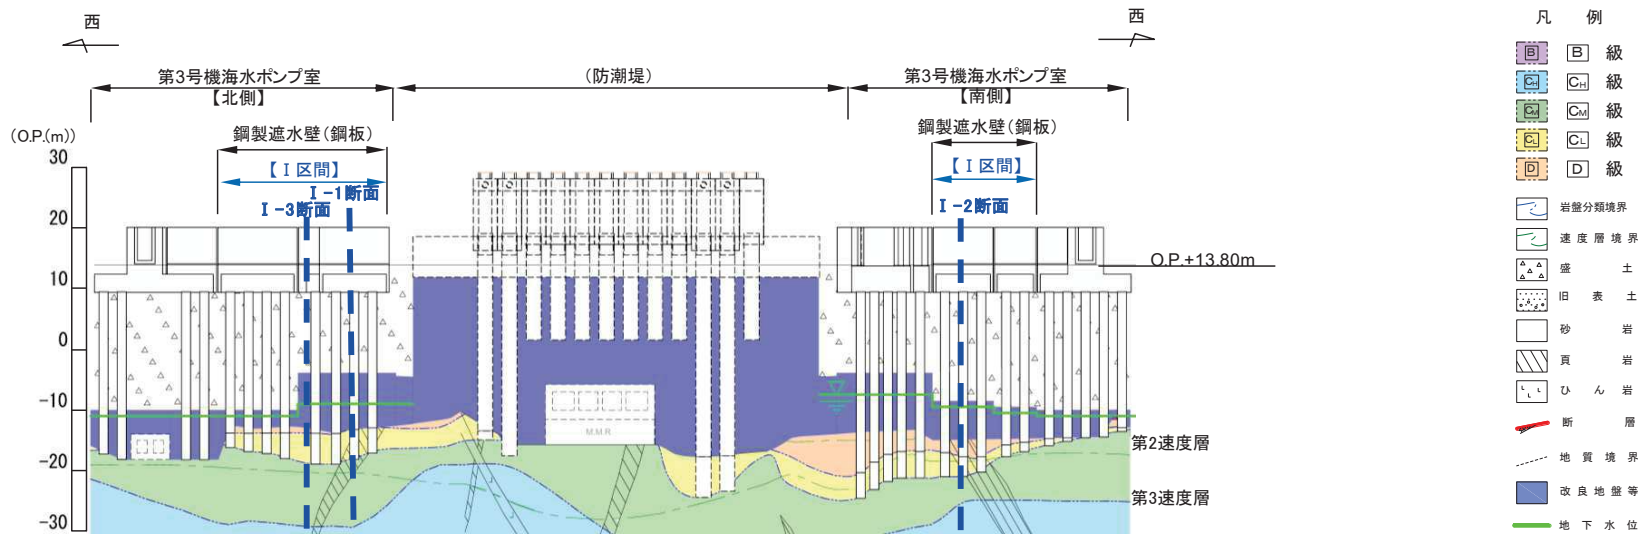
(3) 評価候補断面の地質縦断図 (第3号機海水ポンプ室)
